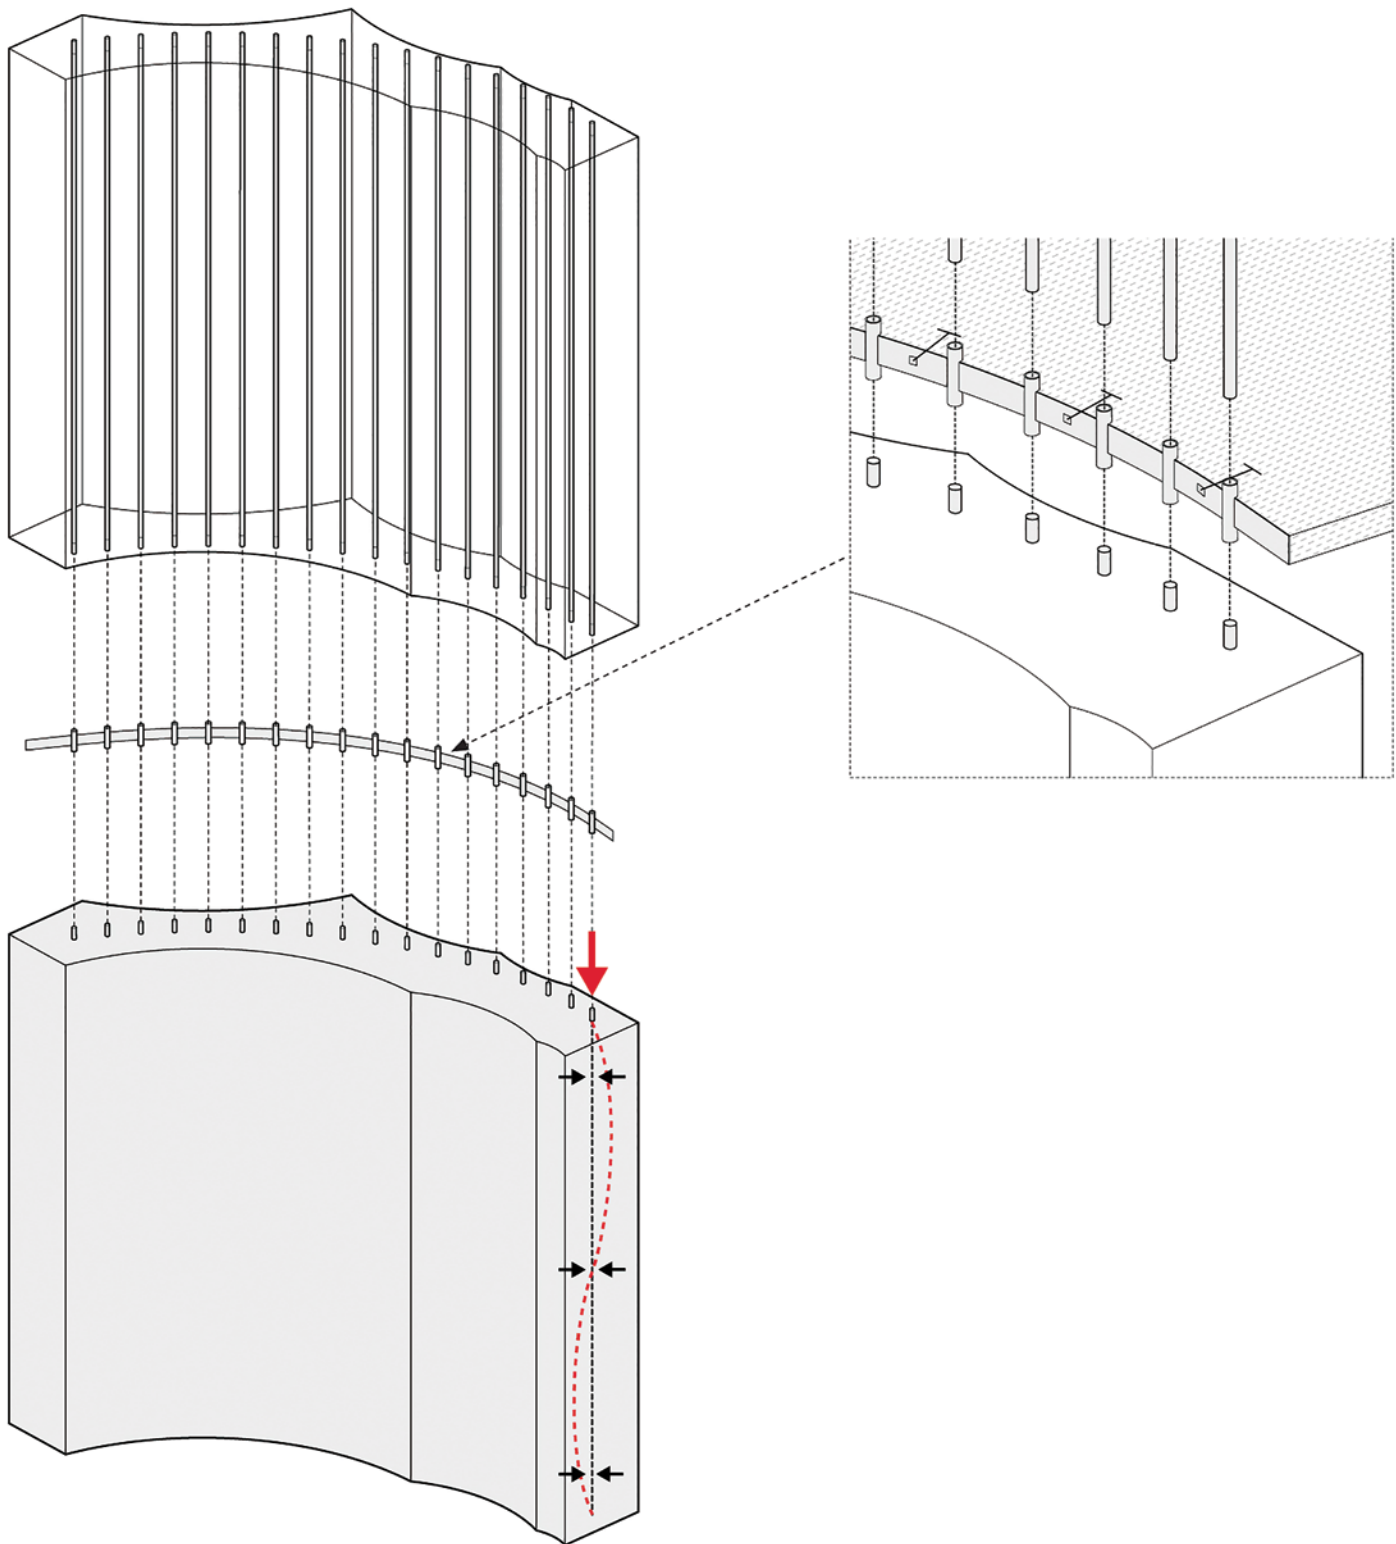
Konstruktionsprinzip der Stabwände mit Infraleichtbeton
